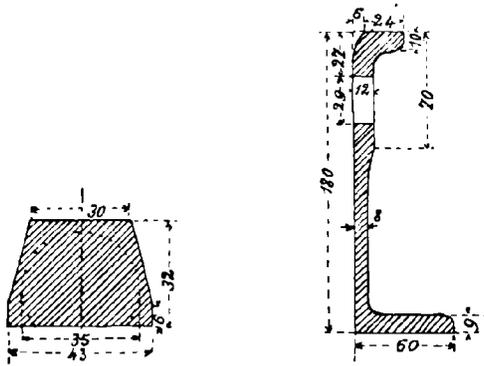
et 76. — Crémaillère de la Maschinen-Fabrik de Berne.
